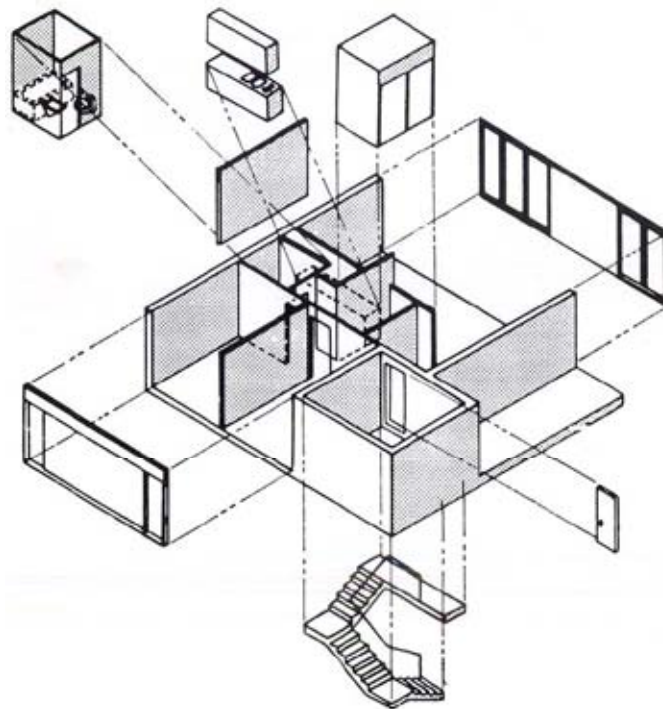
Componentes. La integración total de componentes de diferentes fabricantes que se pueden combinar.<sup>18</sup>
